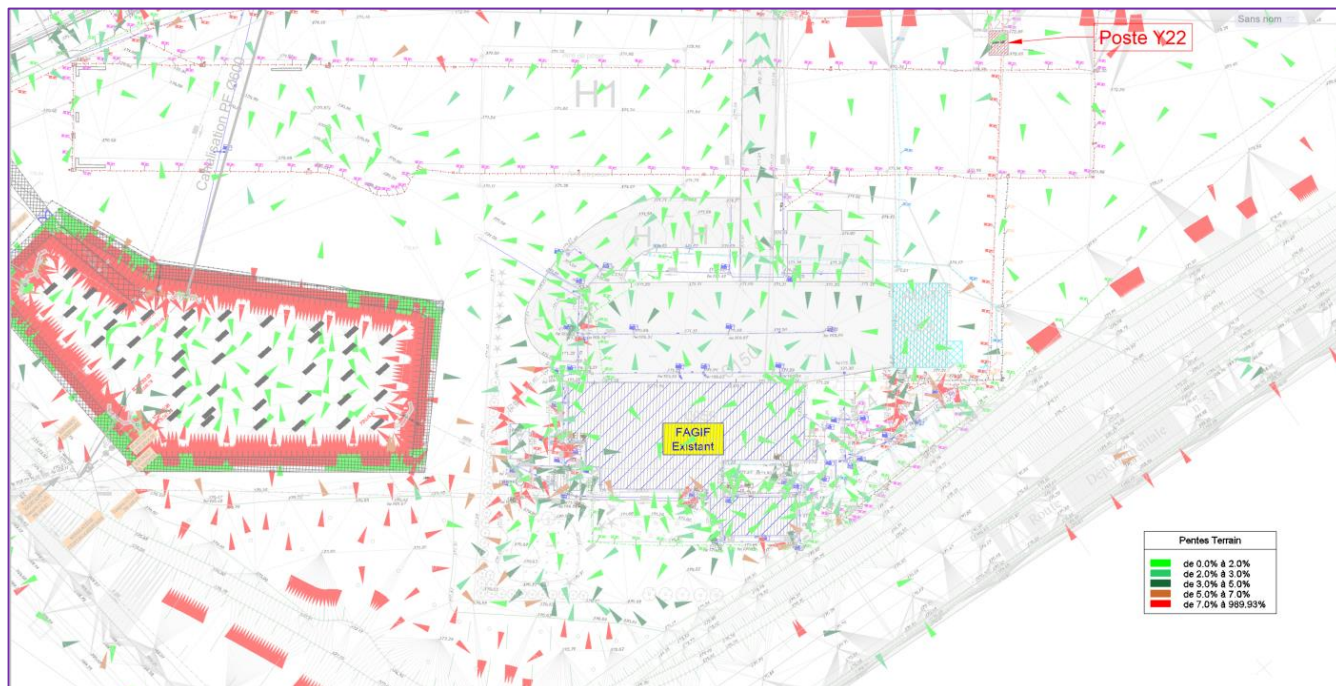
modèle numérique de terrain (MNT) sur le fond de plan de la BA107 (extrait planche 3 annexe 1)
